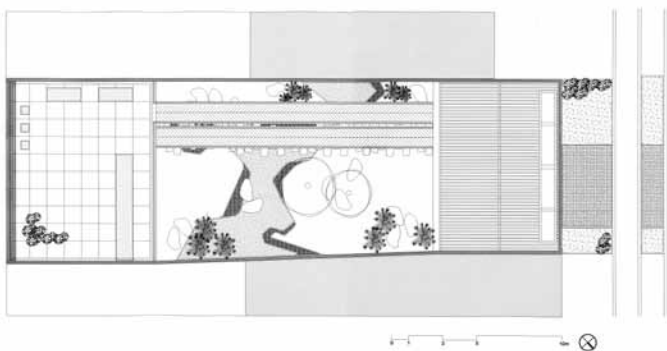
Isaza, Juan Carlos y Ávila, Carlos. Planta de cubierta casa-estudio Isaza-Ávila.
